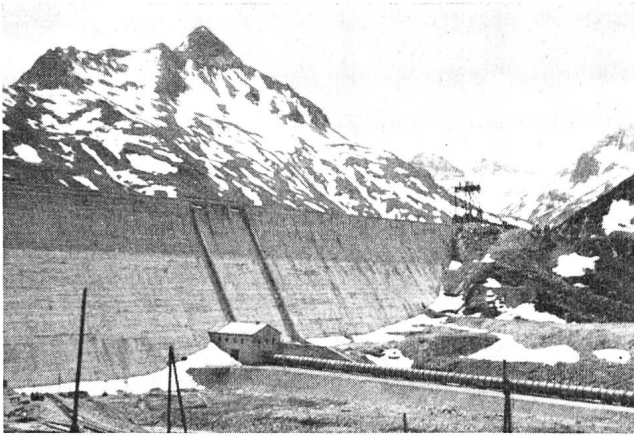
Silvertastaumauer mit abgehender Druckleitung
